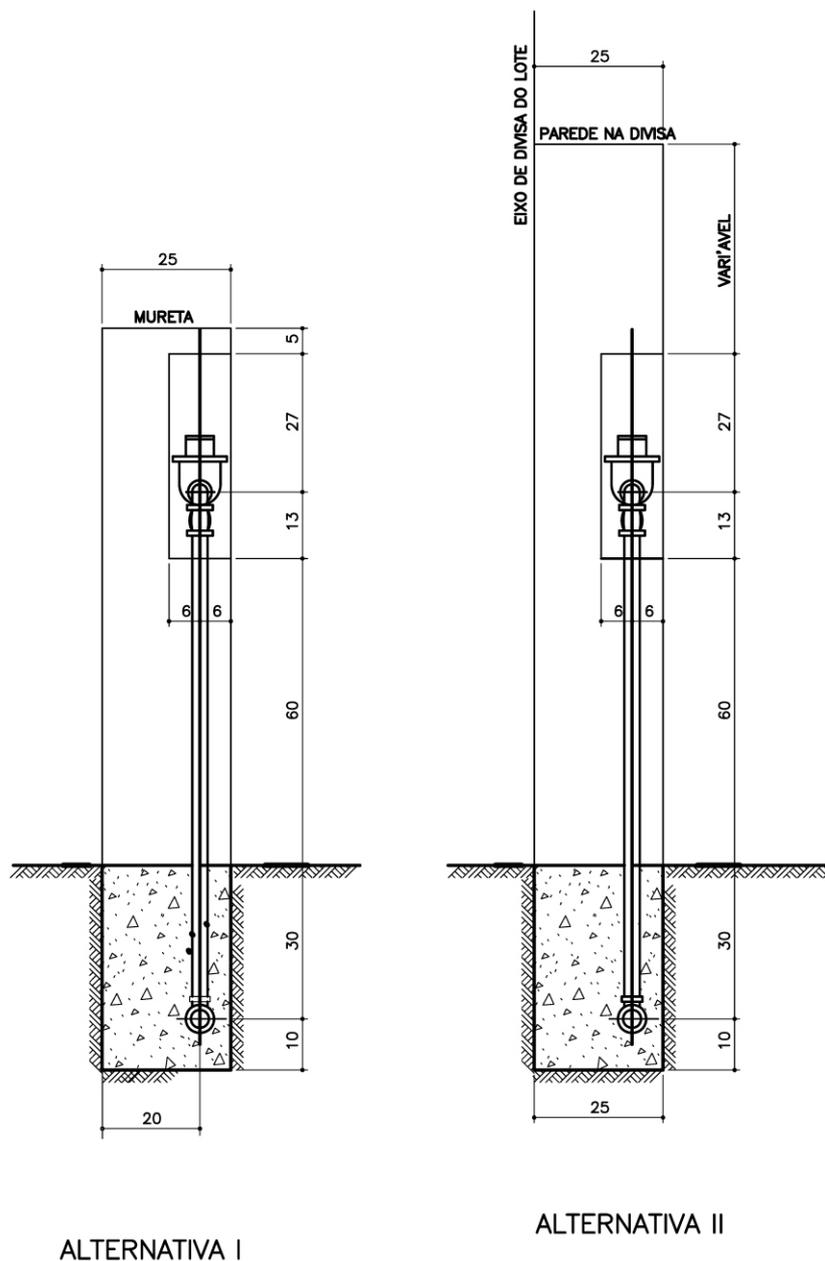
Instalação do padrão COPASA embutido em muro ou mureta – corte
